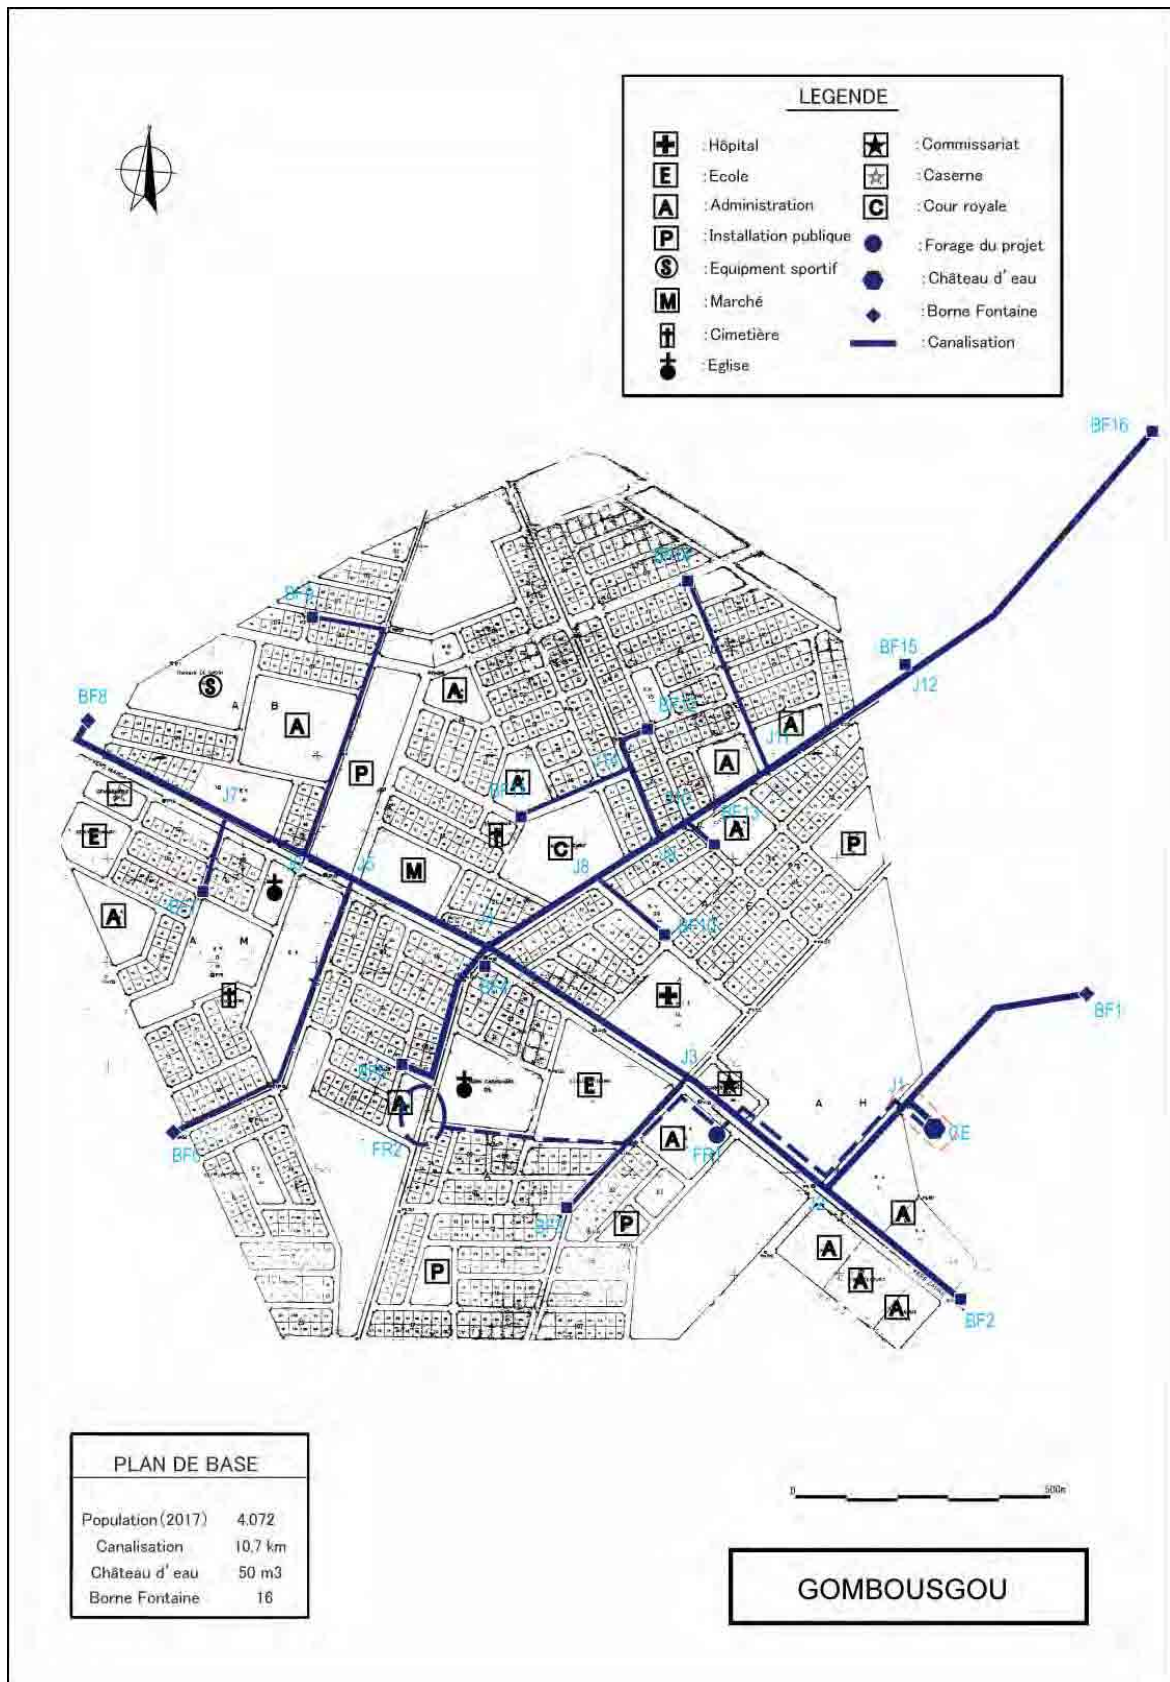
Plan planimétrique de l'AEPS à Gomboussou
